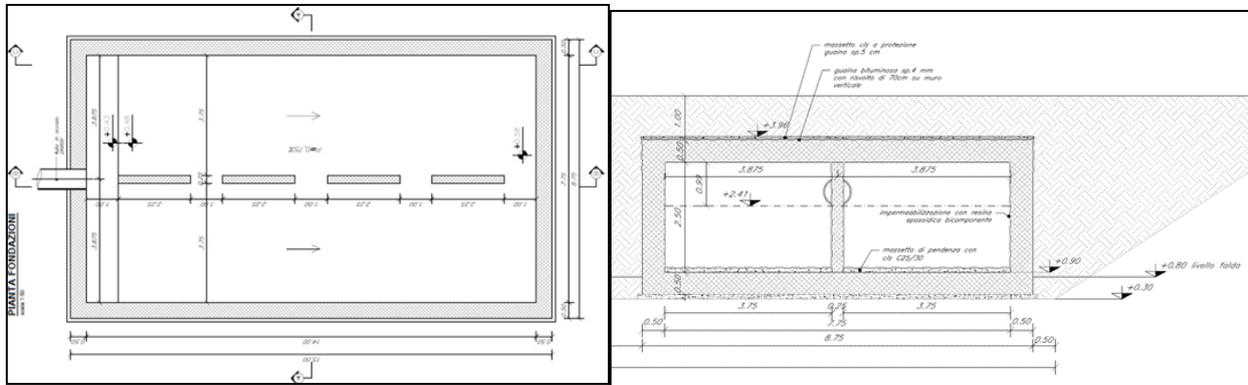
Pianta e sezioni della vasca di raccolta dei liquidi pericolosi
